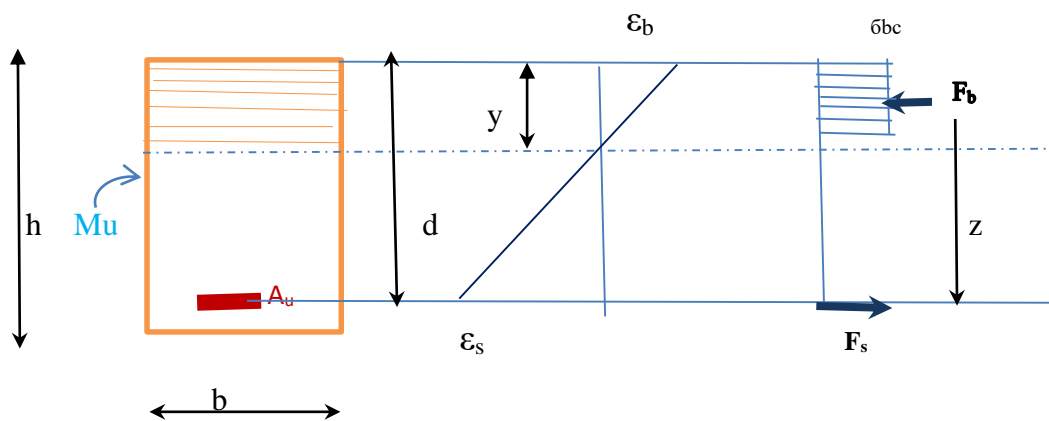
Equilibre statique d'une section rectangulaire fléchie à l'ELUR
